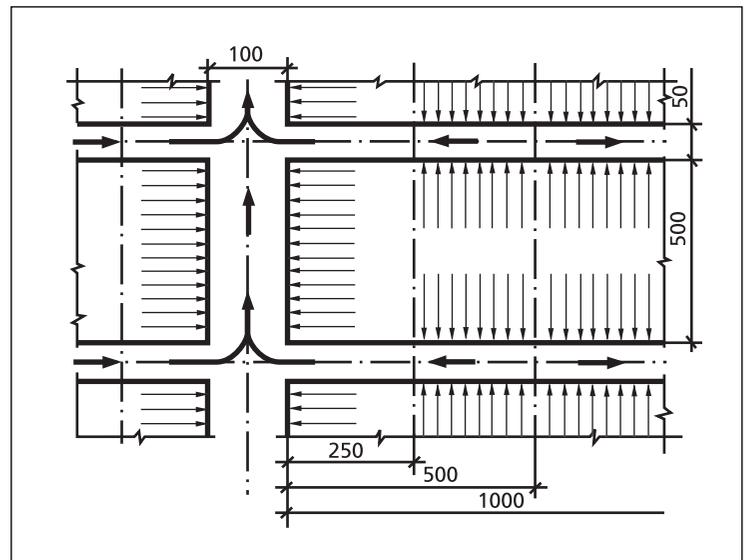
Расчетная схема вентиляции каналов и диффузии водяного пара
